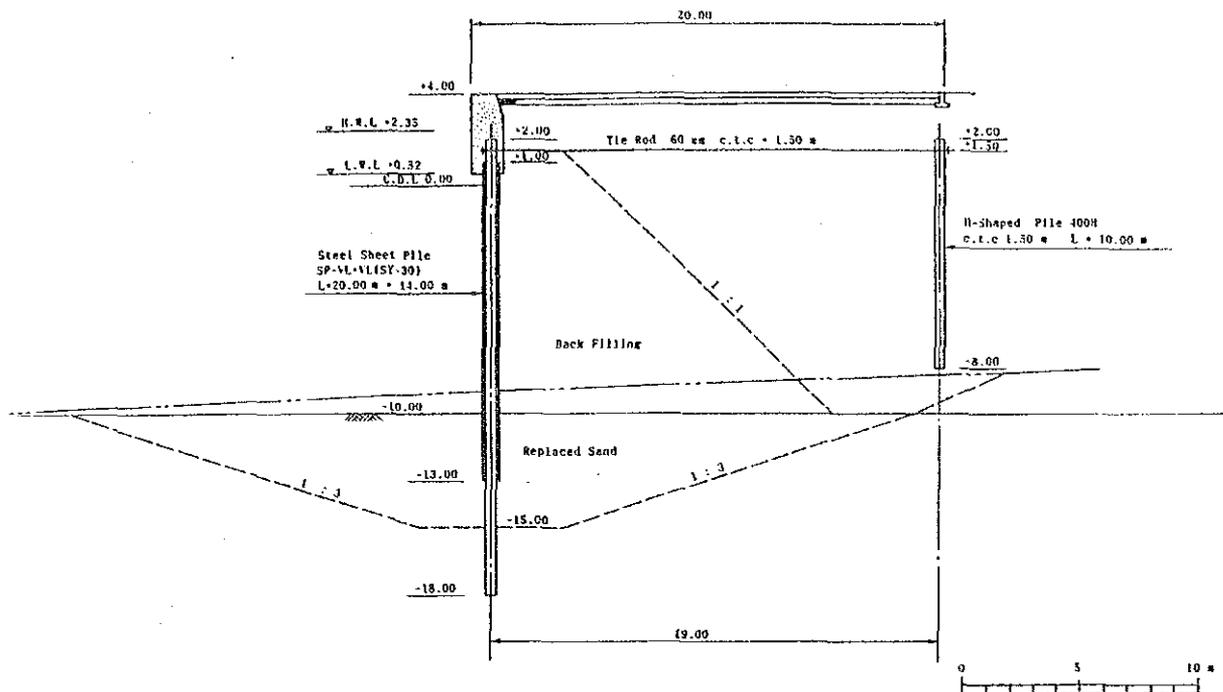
Coupe transversale typique du nouveau poste de mouillage
